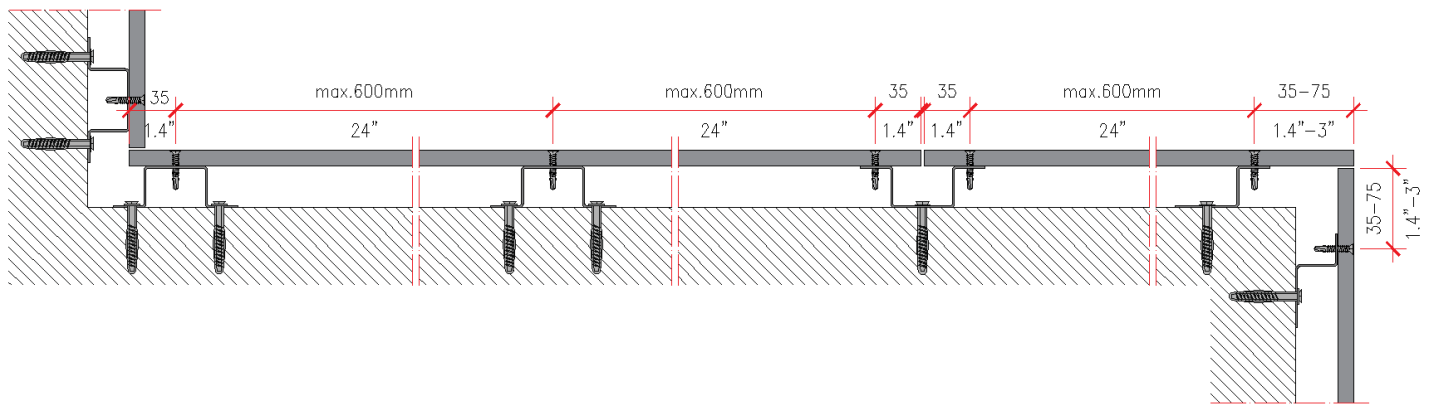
Secção horizontal de revestimento de parede, estrutura de aço galvanizado
